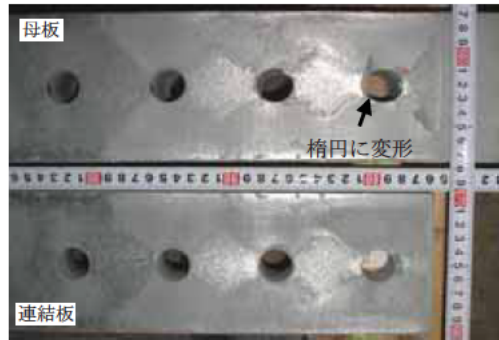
試験体 No.15-1 (連結板外側の端部を拡大したもの)
